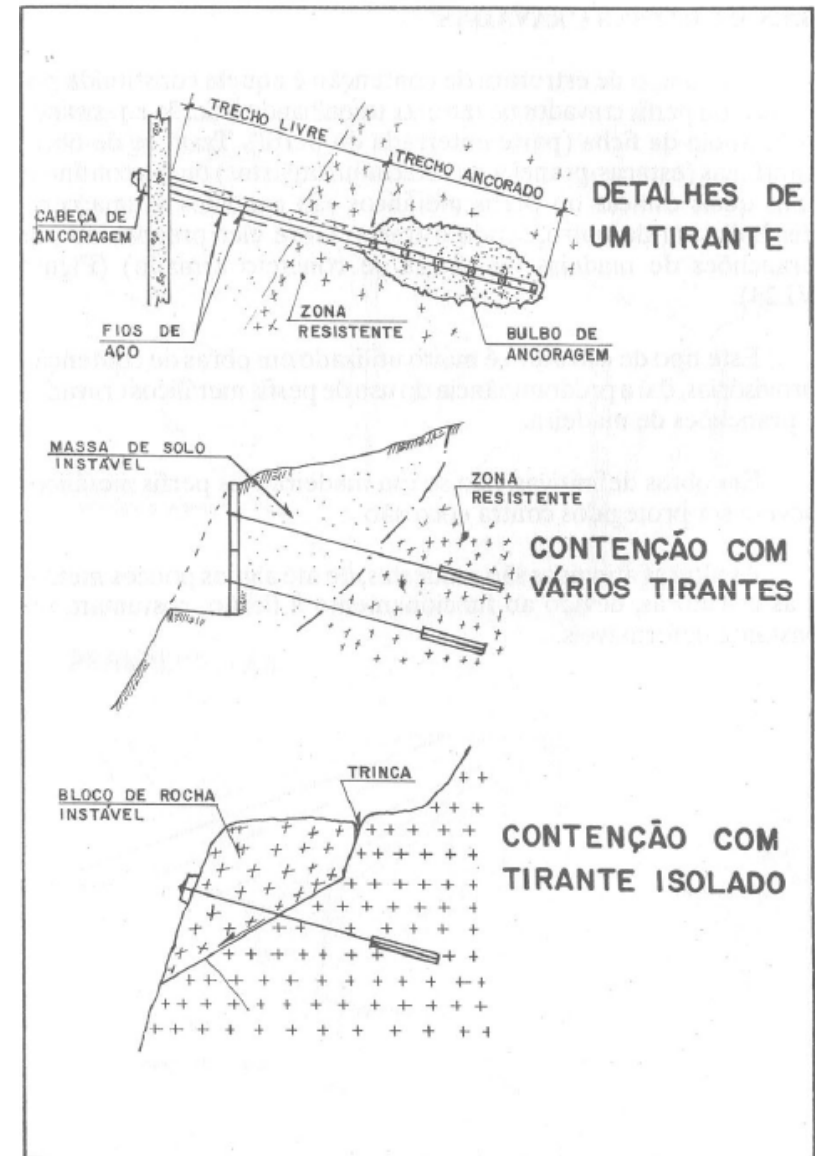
Detalhes de um tirante e exemplos de aplicação
